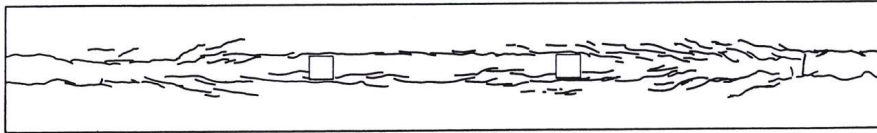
Profil de fissuration des poutres testées par (Bacchetta et Bachmann, 1977)
